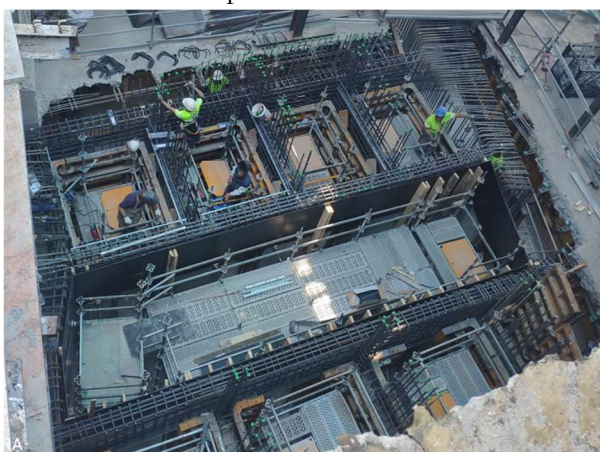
emparrillado de vigas de cimentación del núcleo de ascensores
